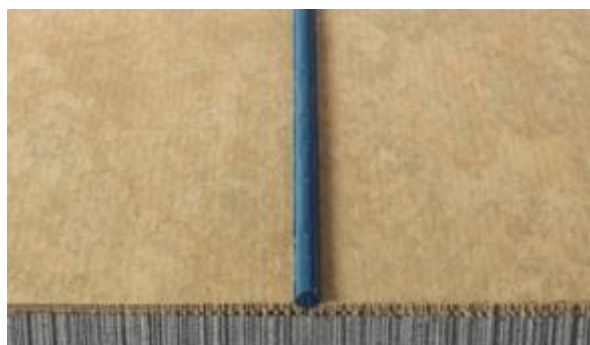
Cordão de soldadura após o processo de soldadura a quente [24]
